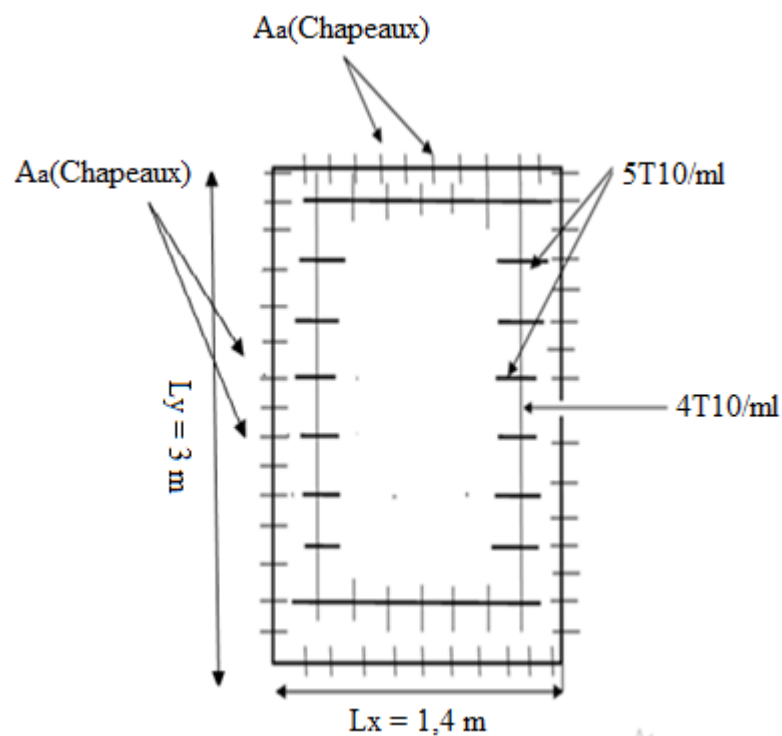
Schéma ferrailage du panneau de la dalle pleine.
